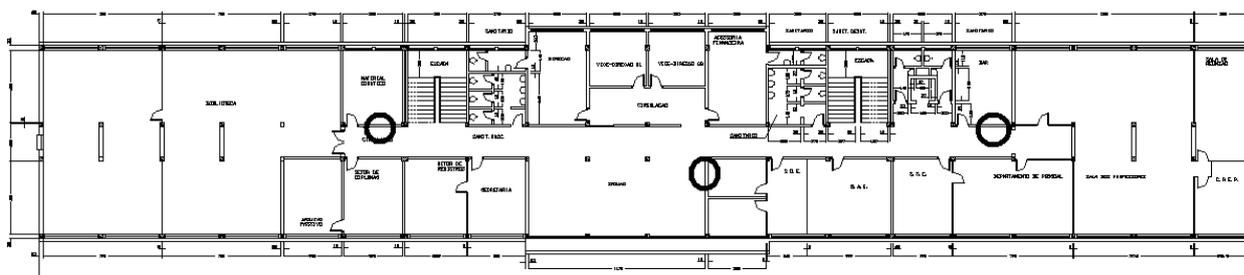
Localização recomendada para as tomadas de incêndio do segundo pavimento.
